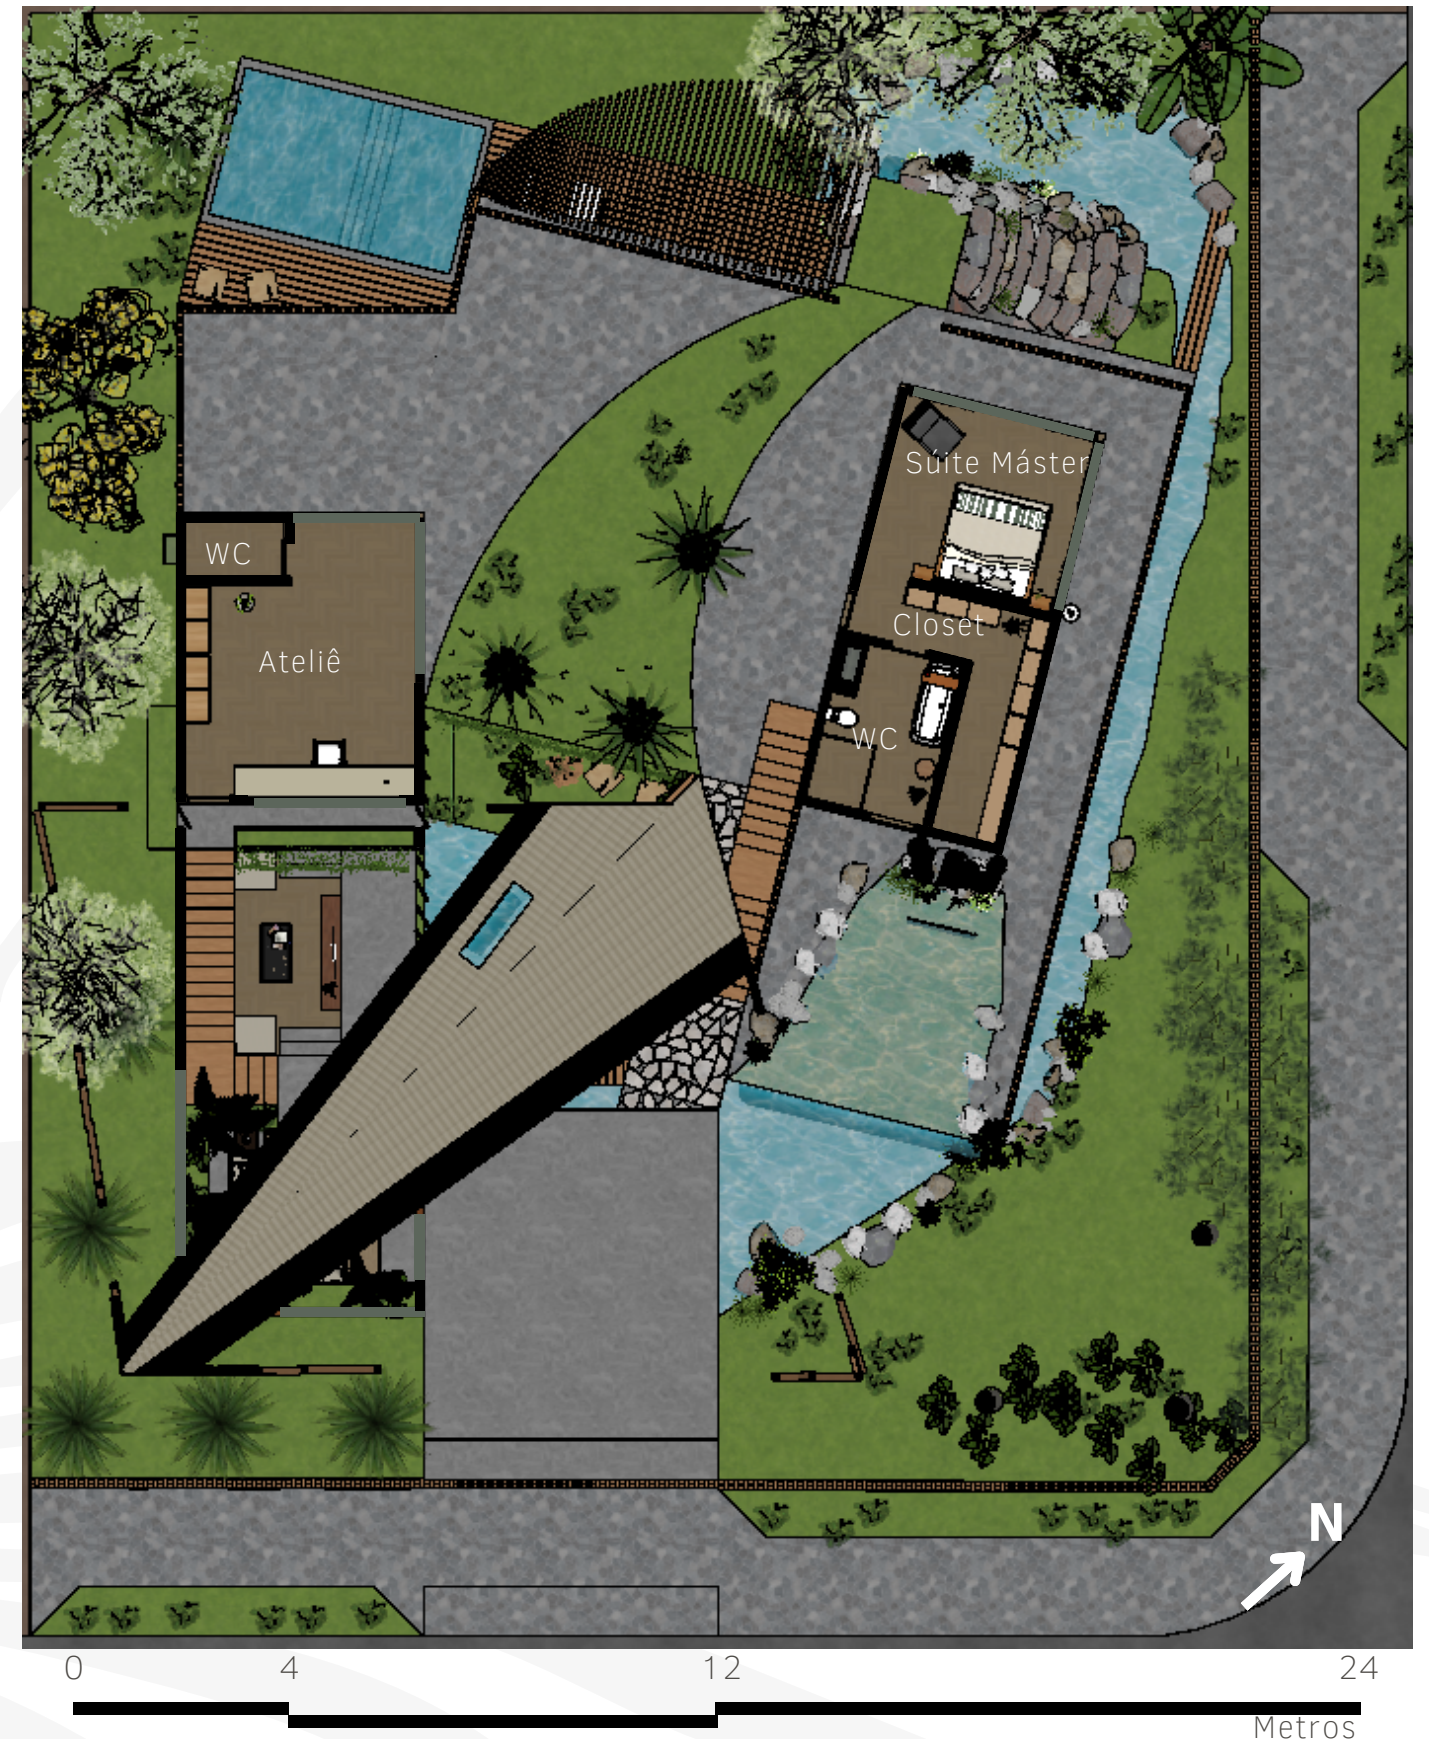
Planta baixa do projeto. Fonte: Elaboração própria da autora.
